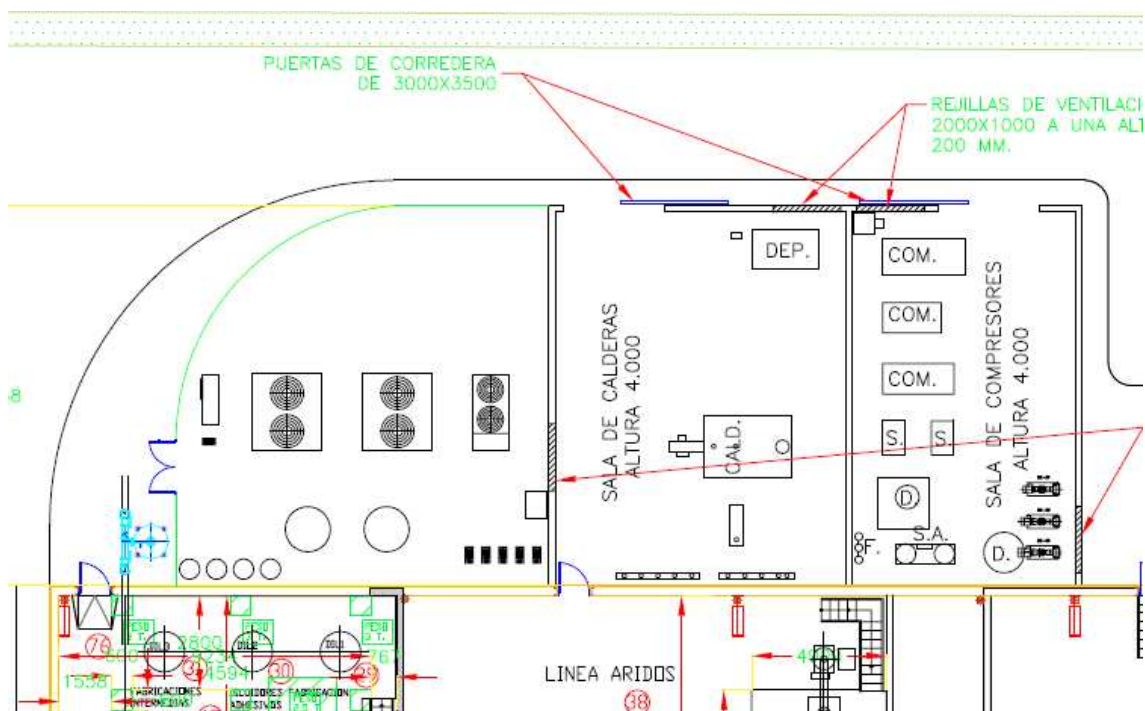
Detalle del plano general actual de la planta sobre la zona de la sala de calderas.
